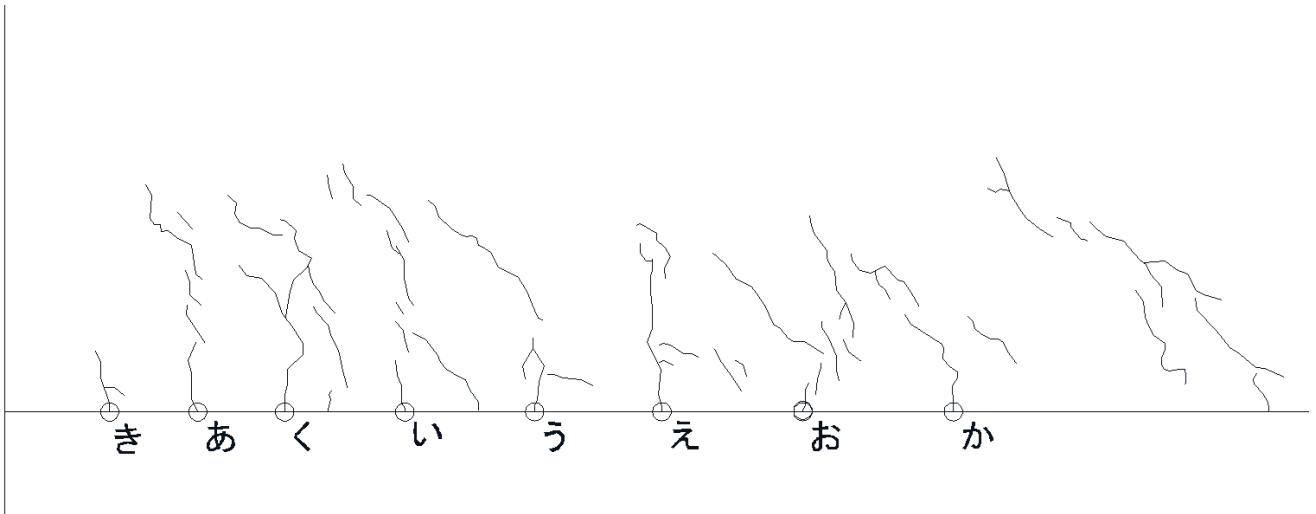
基礎梁ひび割れ幅測定位置(試験体 D-2 正載荷)
